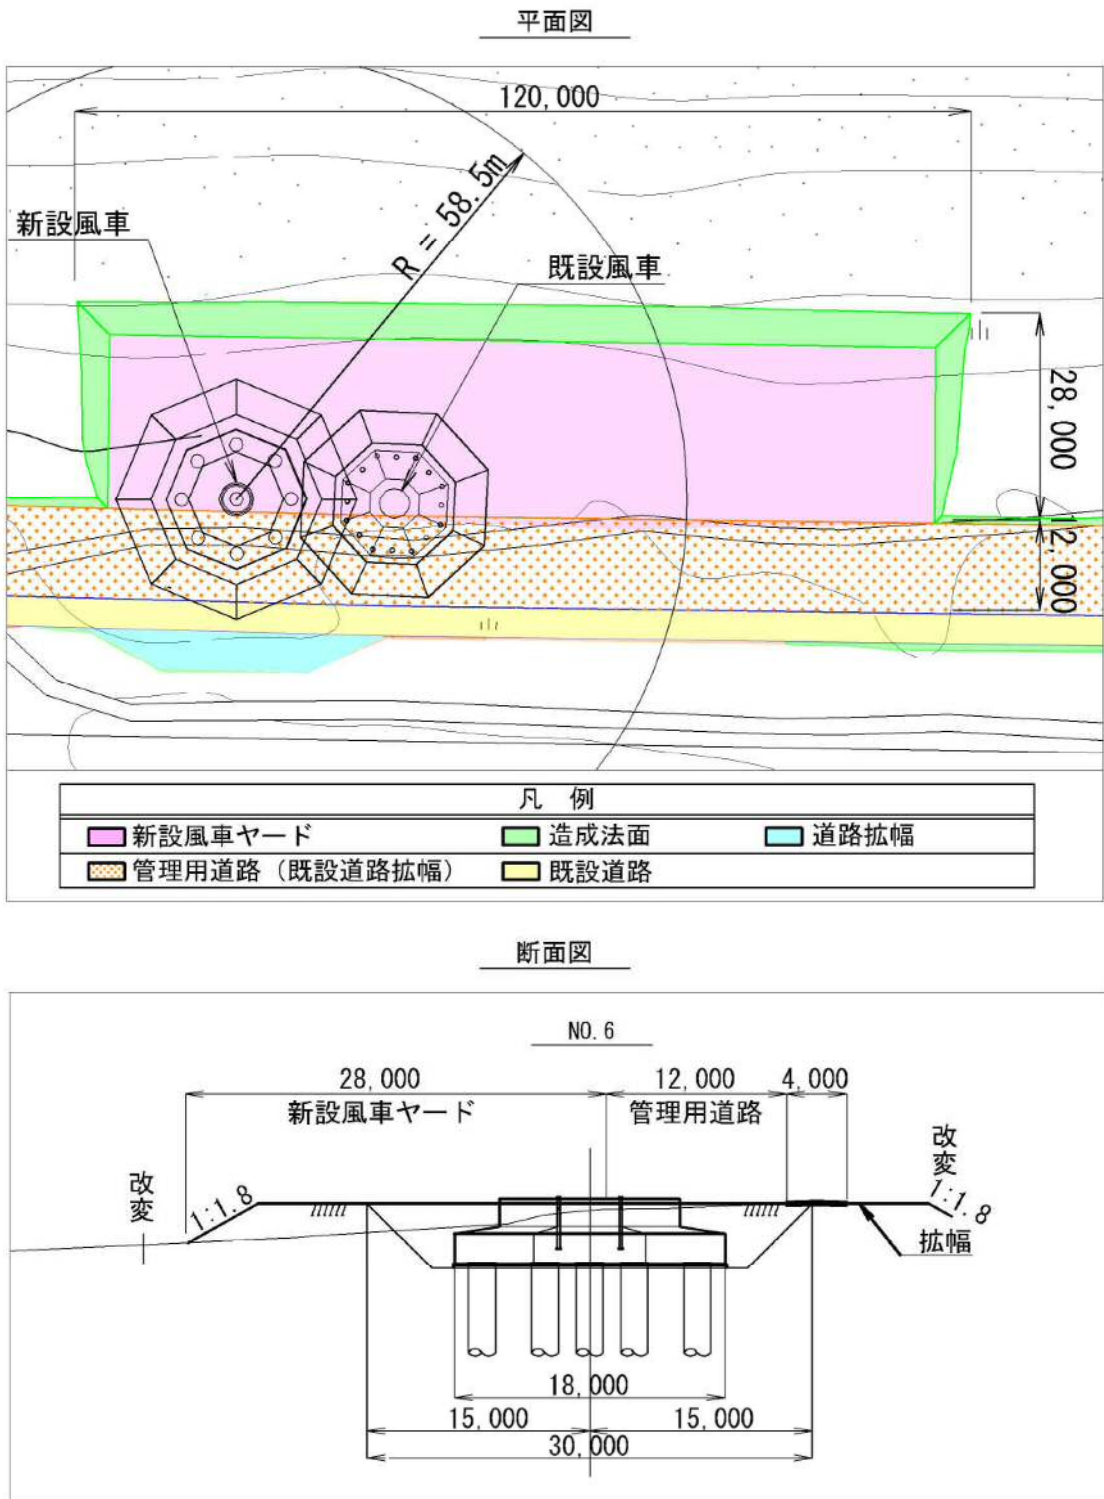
(6) 造成平面・横断計画図（新設 6 号機）
